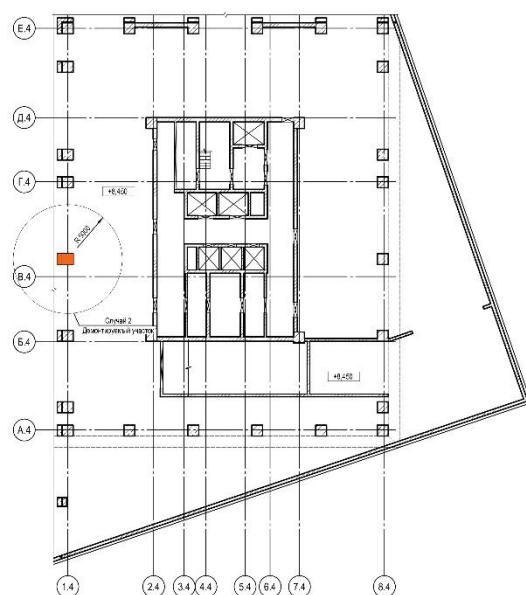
Корпус К-4. Схема аварийного случая 2
